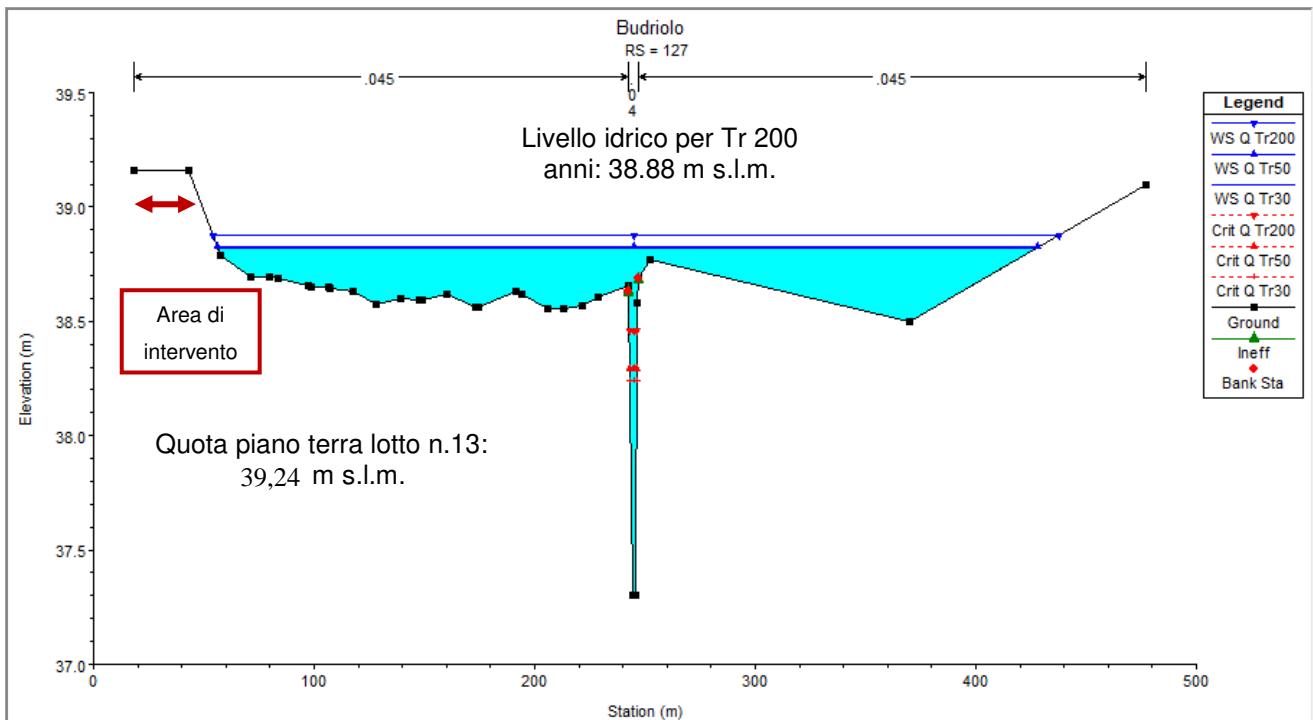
tiranti idrici nella sezione RS=127, a valle della nuova lottizzazione – stato di progetto
